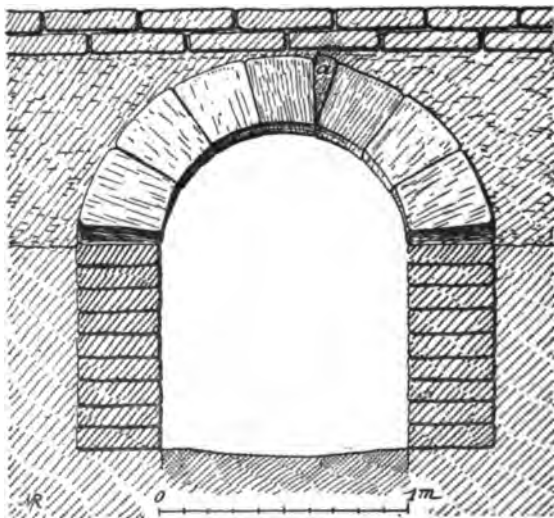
Coupe transversale d'un aqueduc de Khorsabad (d'après V. Place).
